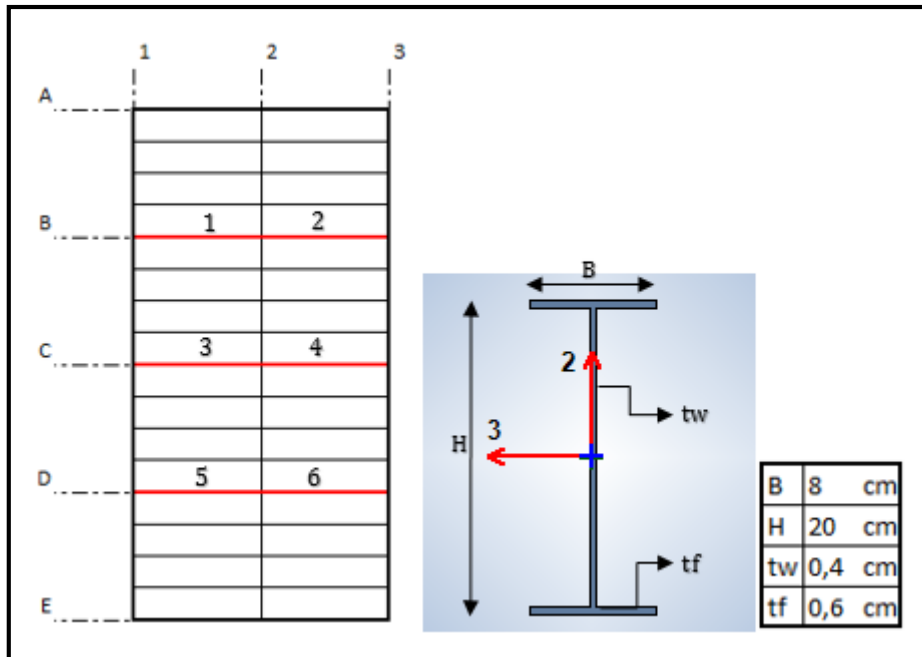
Dimensiones de vigas centrales en "X" con pórticos arriostrados.
